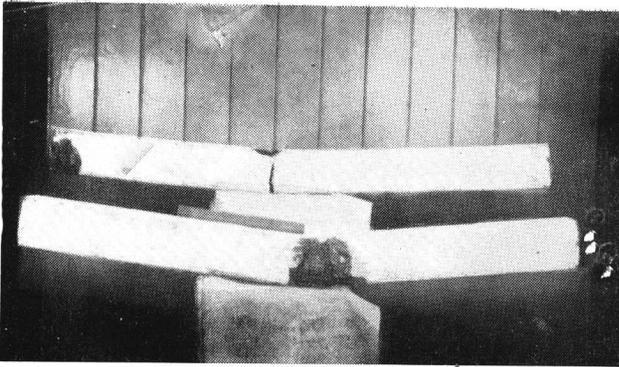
Fotografía de las vigas después del ensayo a la rotura
